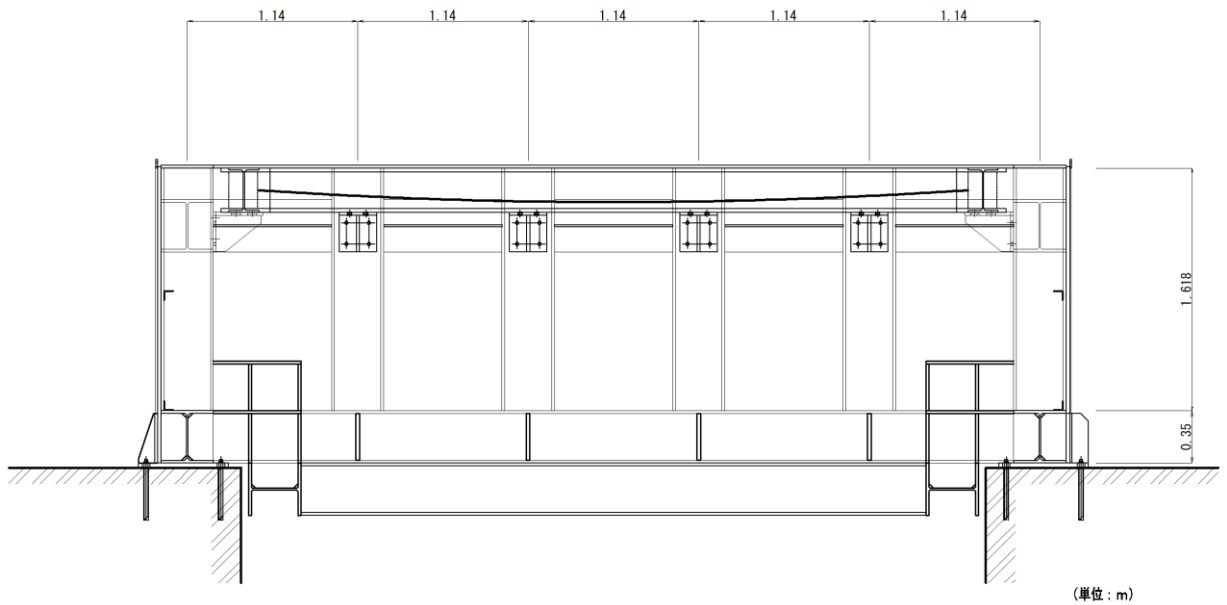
取水槽海水ポンプエリア竜巻防護対策設備の平面図
